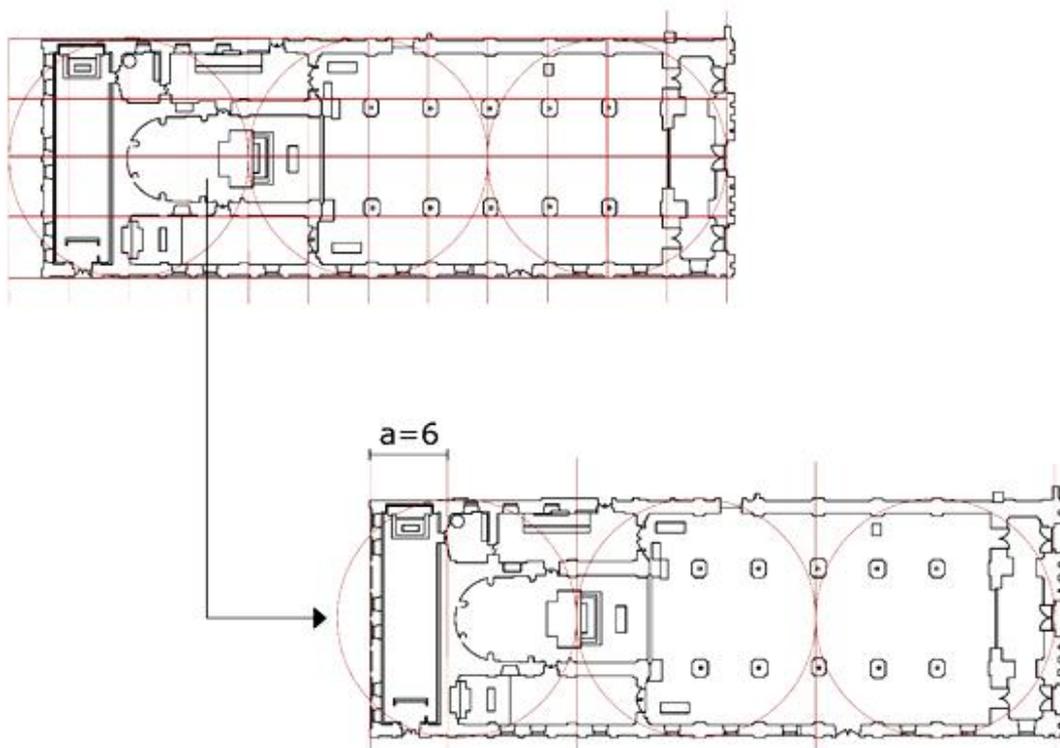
Análisis Planta Arquitectónica Iglesia Santo Domingo Cuenca.
